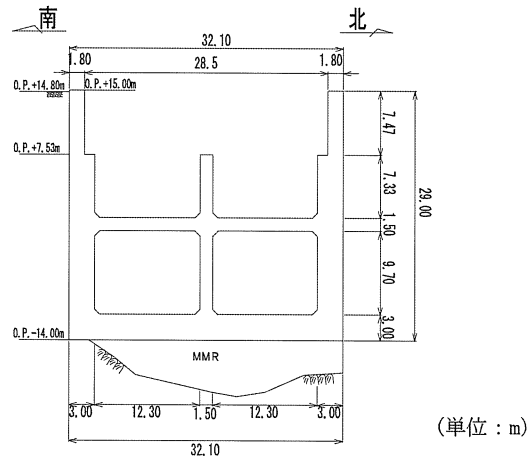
第 3 号機海水ポンプ室断面図 (B-B 断面)
